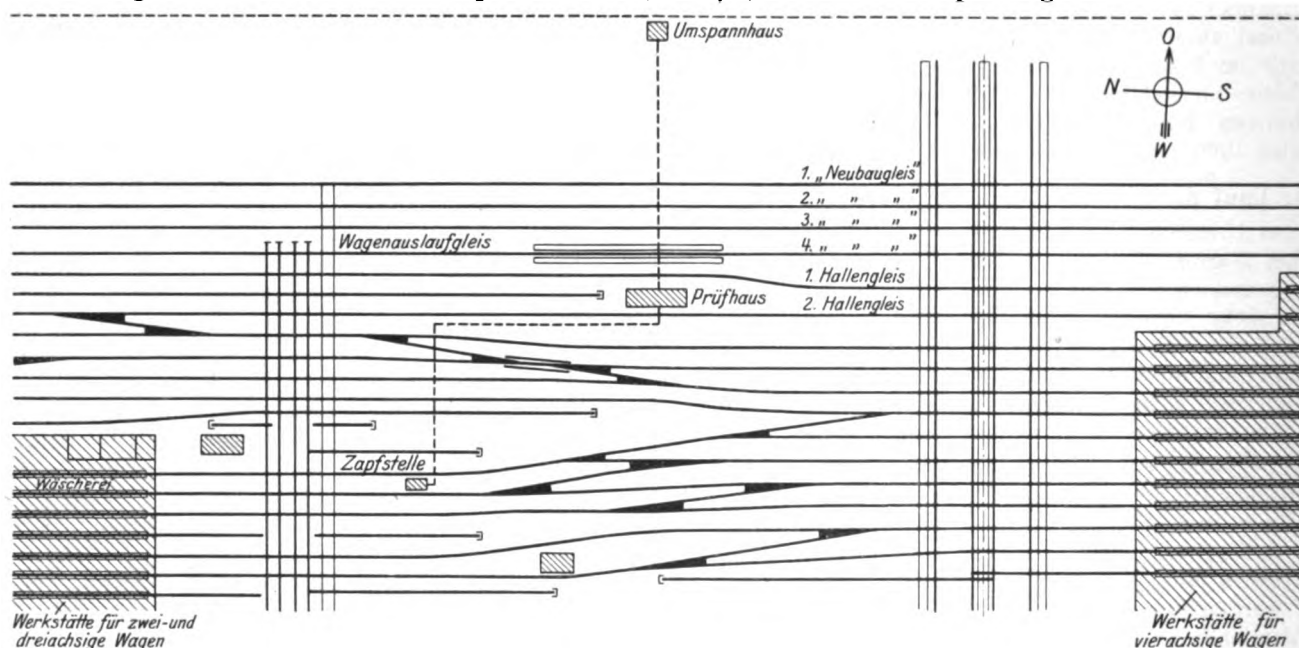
Lageplan der elektrischen Zugheizungs-Prüfanlage.
